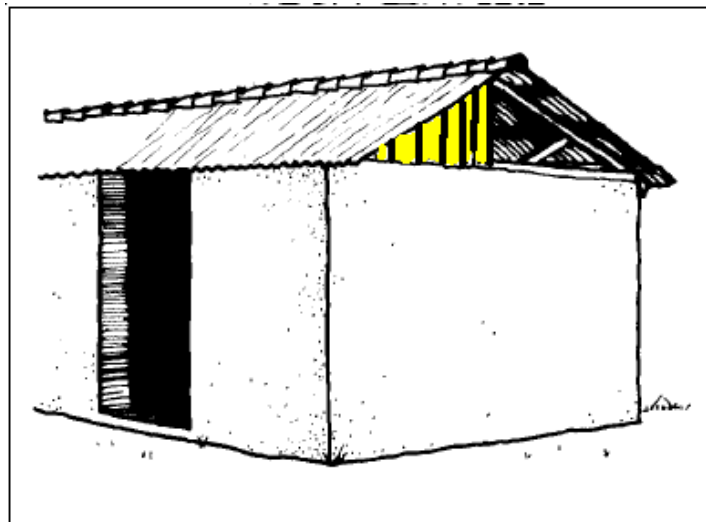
Tímpano fijado en la estructura de la cubierta.
